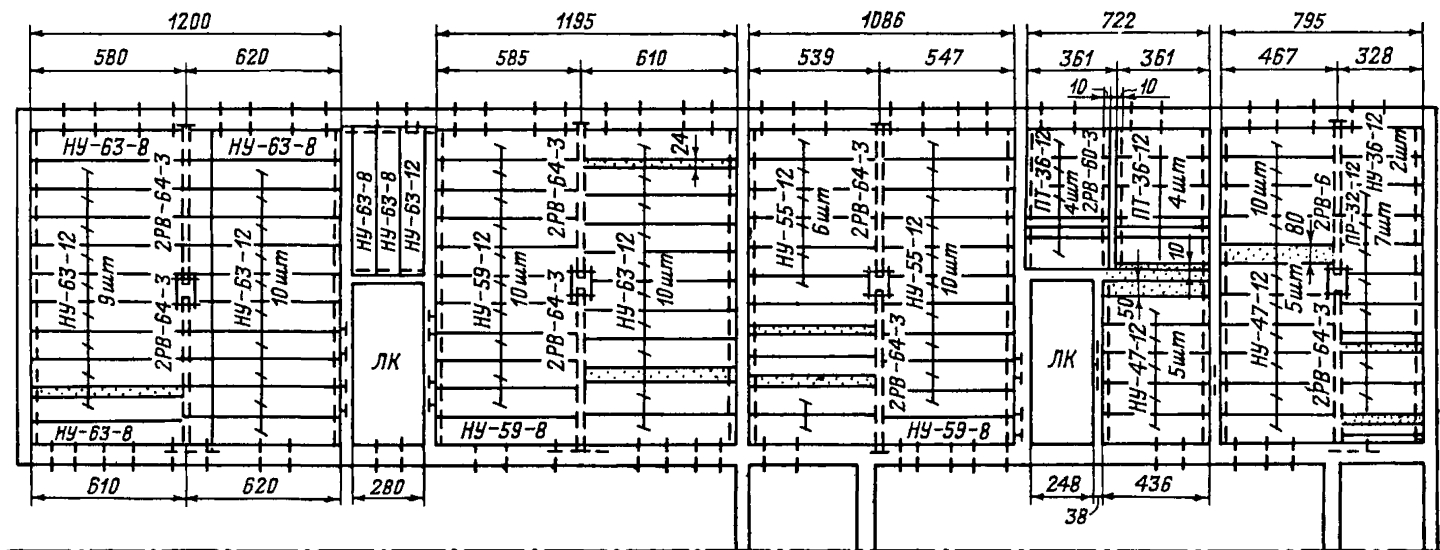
Схема расположения готовых железобетонных настилов нового строительства
